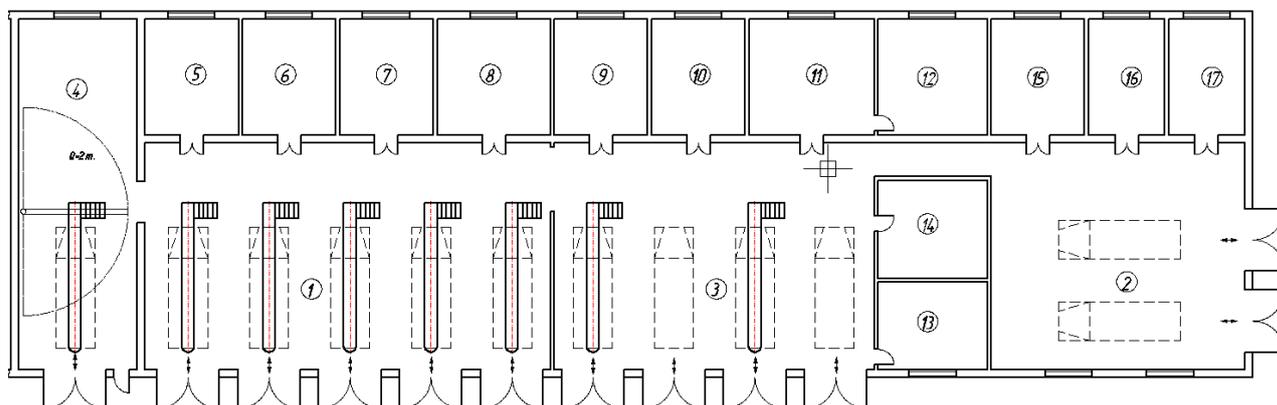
План производственного корпуса: 1 – зона ТР; 2 – зона УМР; 3 – зона ТО; 4 – агрегатный участок; 5 – шиномонтажный участок; 6 – медницкий участок; 7 – сварочный участок; 8 – кузнечно-рессорный участок; 9 – слесарно-механический участок; 10 – аккумуляторный участок; 11 – склад смазочных материалов; 12 – склад инструментов, материалов, запчастей; 13 – электротехнический участок; 14 – участок ремонта топливной аппаратуры; 15 – комната отдыха, раздевалка; 16 – техническое помещение; 17 – санузел.
